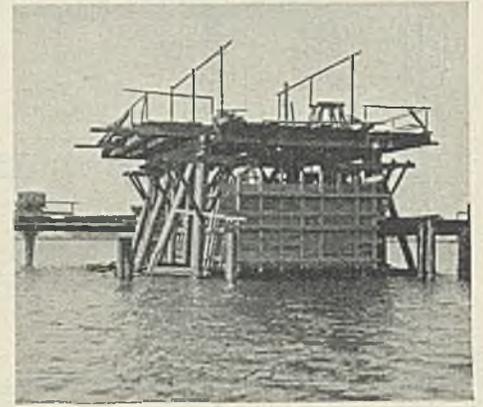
Eisengerippe und Holzschalung hängen in 6 Spindeln am Absenkgerüst.
